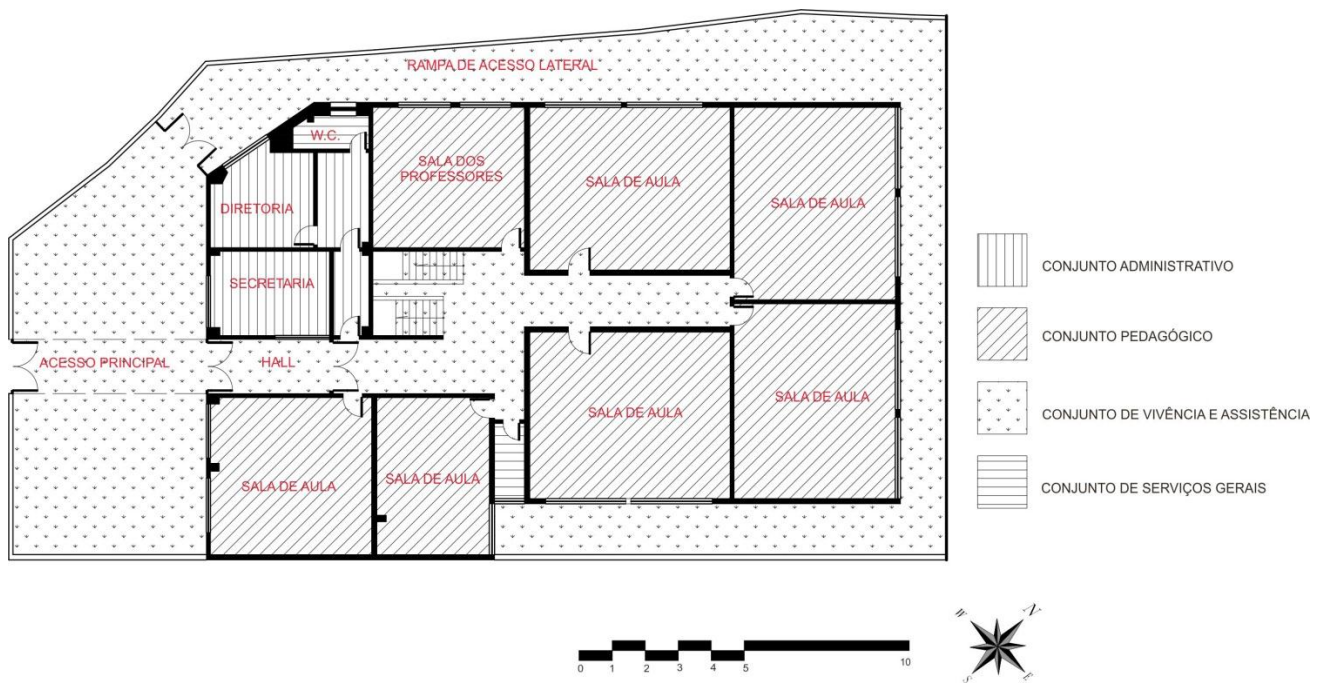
Setorização - planta térreo E. M. Cosette de Alencar (Fonte: a autora)
